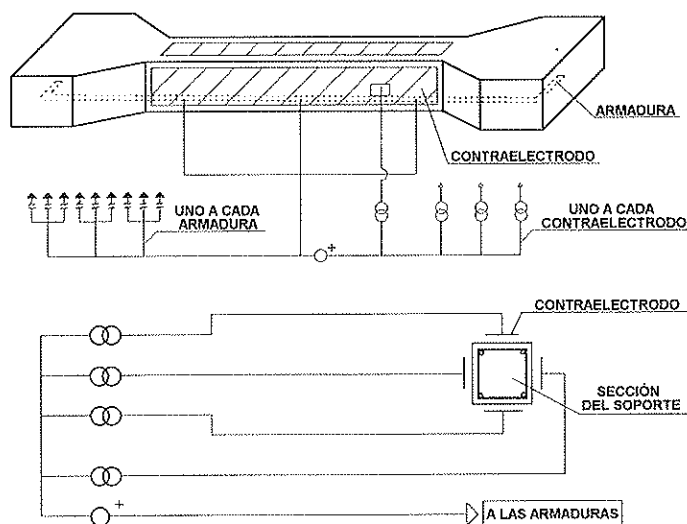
Esquema del dispositivo para la corrosión acelerada de las armaduras en los soportes de hormigón.
